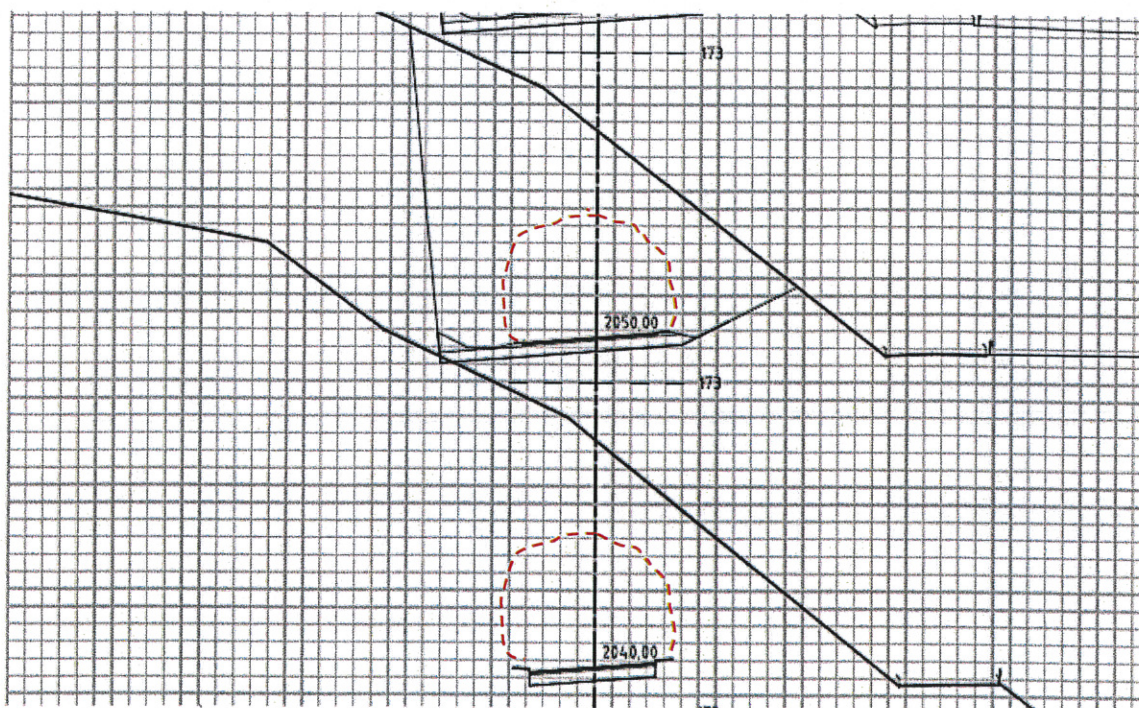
Plan, profil 1900-2170 (tunnelpåhugg profil 2050)
